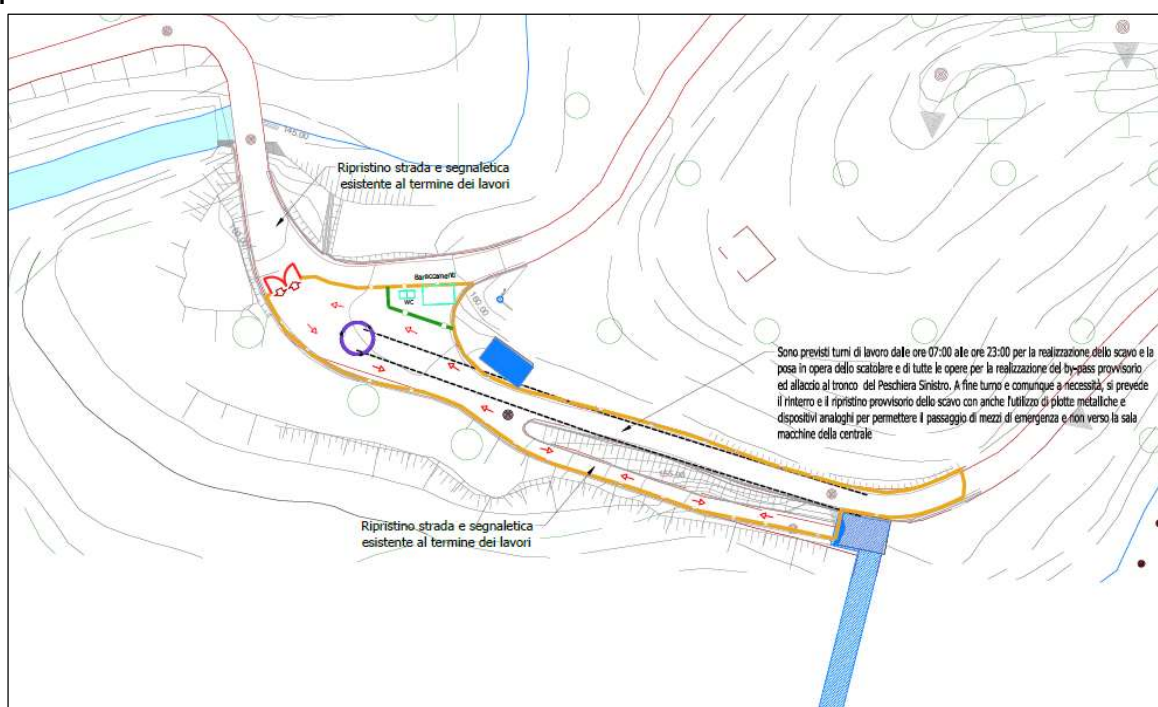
Area di cantiere allaccio al Peschiera Inferiore SX – Viabilità di accesso
